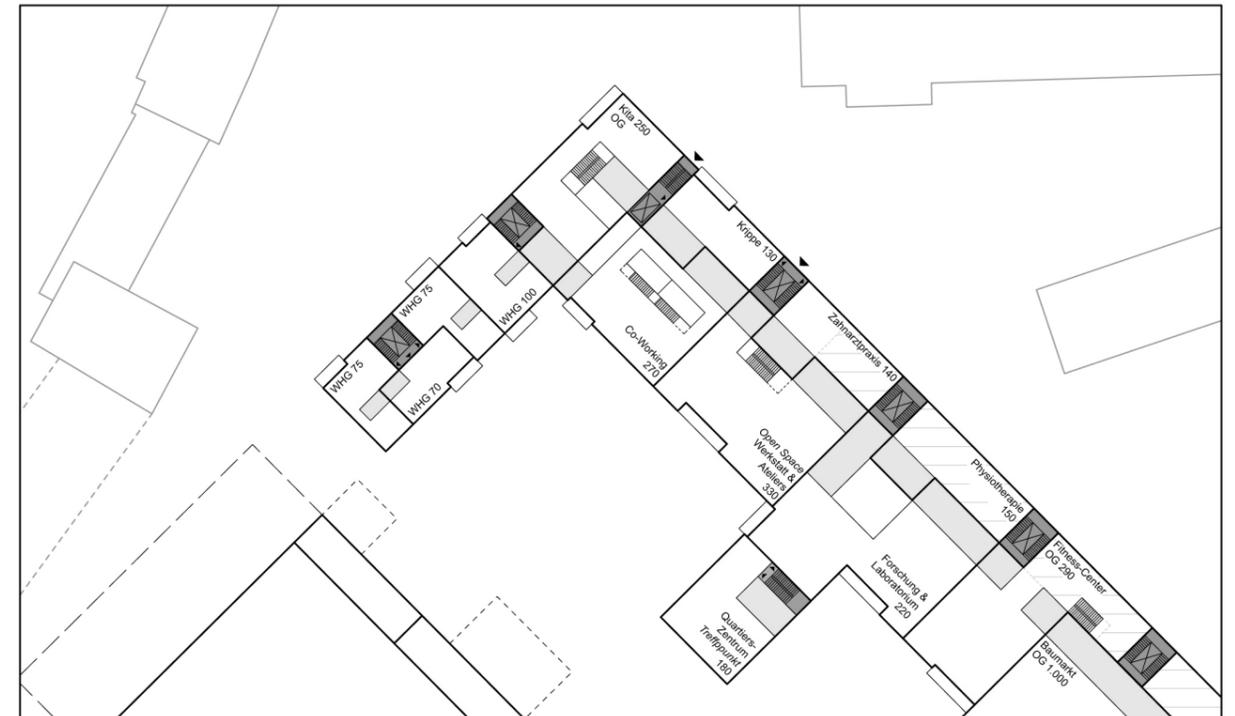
(unten) Schematischer Grundrissauszug EG (o.M.)
